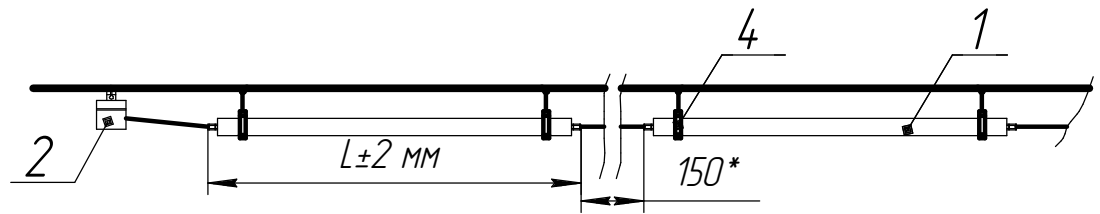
1 - Корпус; 2 - распредел. коробка;
